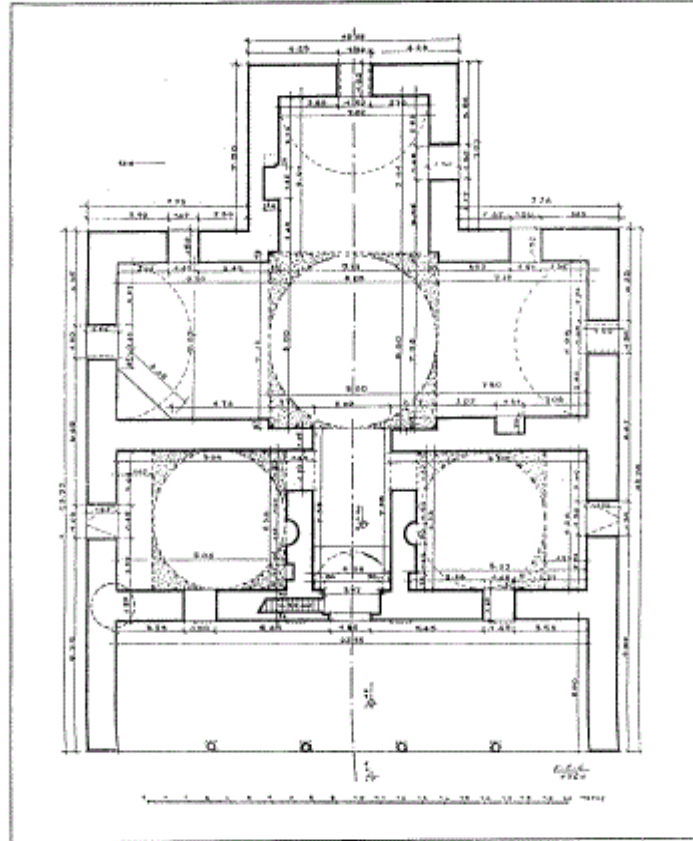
مسقط أفقي لمسجد مراد باشا في إستانبول (عن : كوران) .
